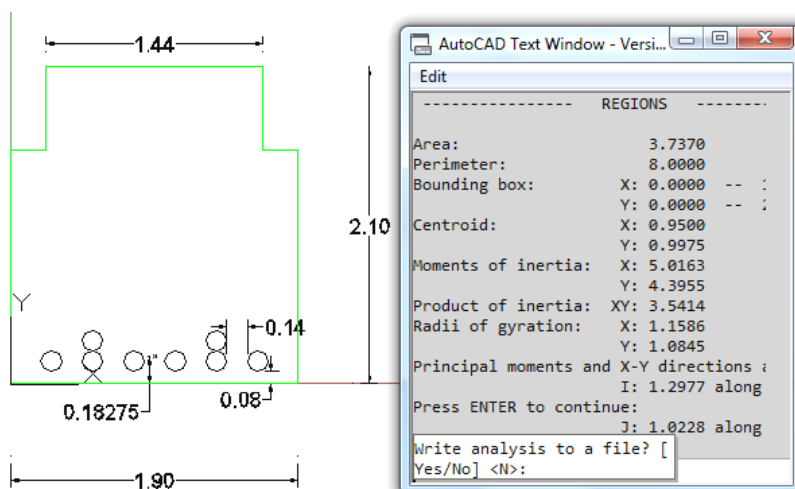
Características da secção transversal da viga B7 (AutoCAD)
